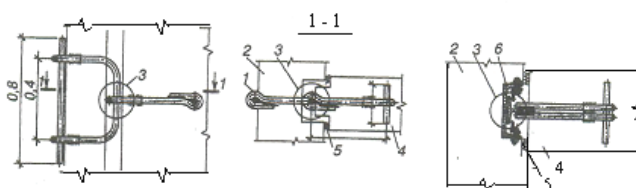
Анкерные устройства для связи стен пристройки и реконструируемого здания:
